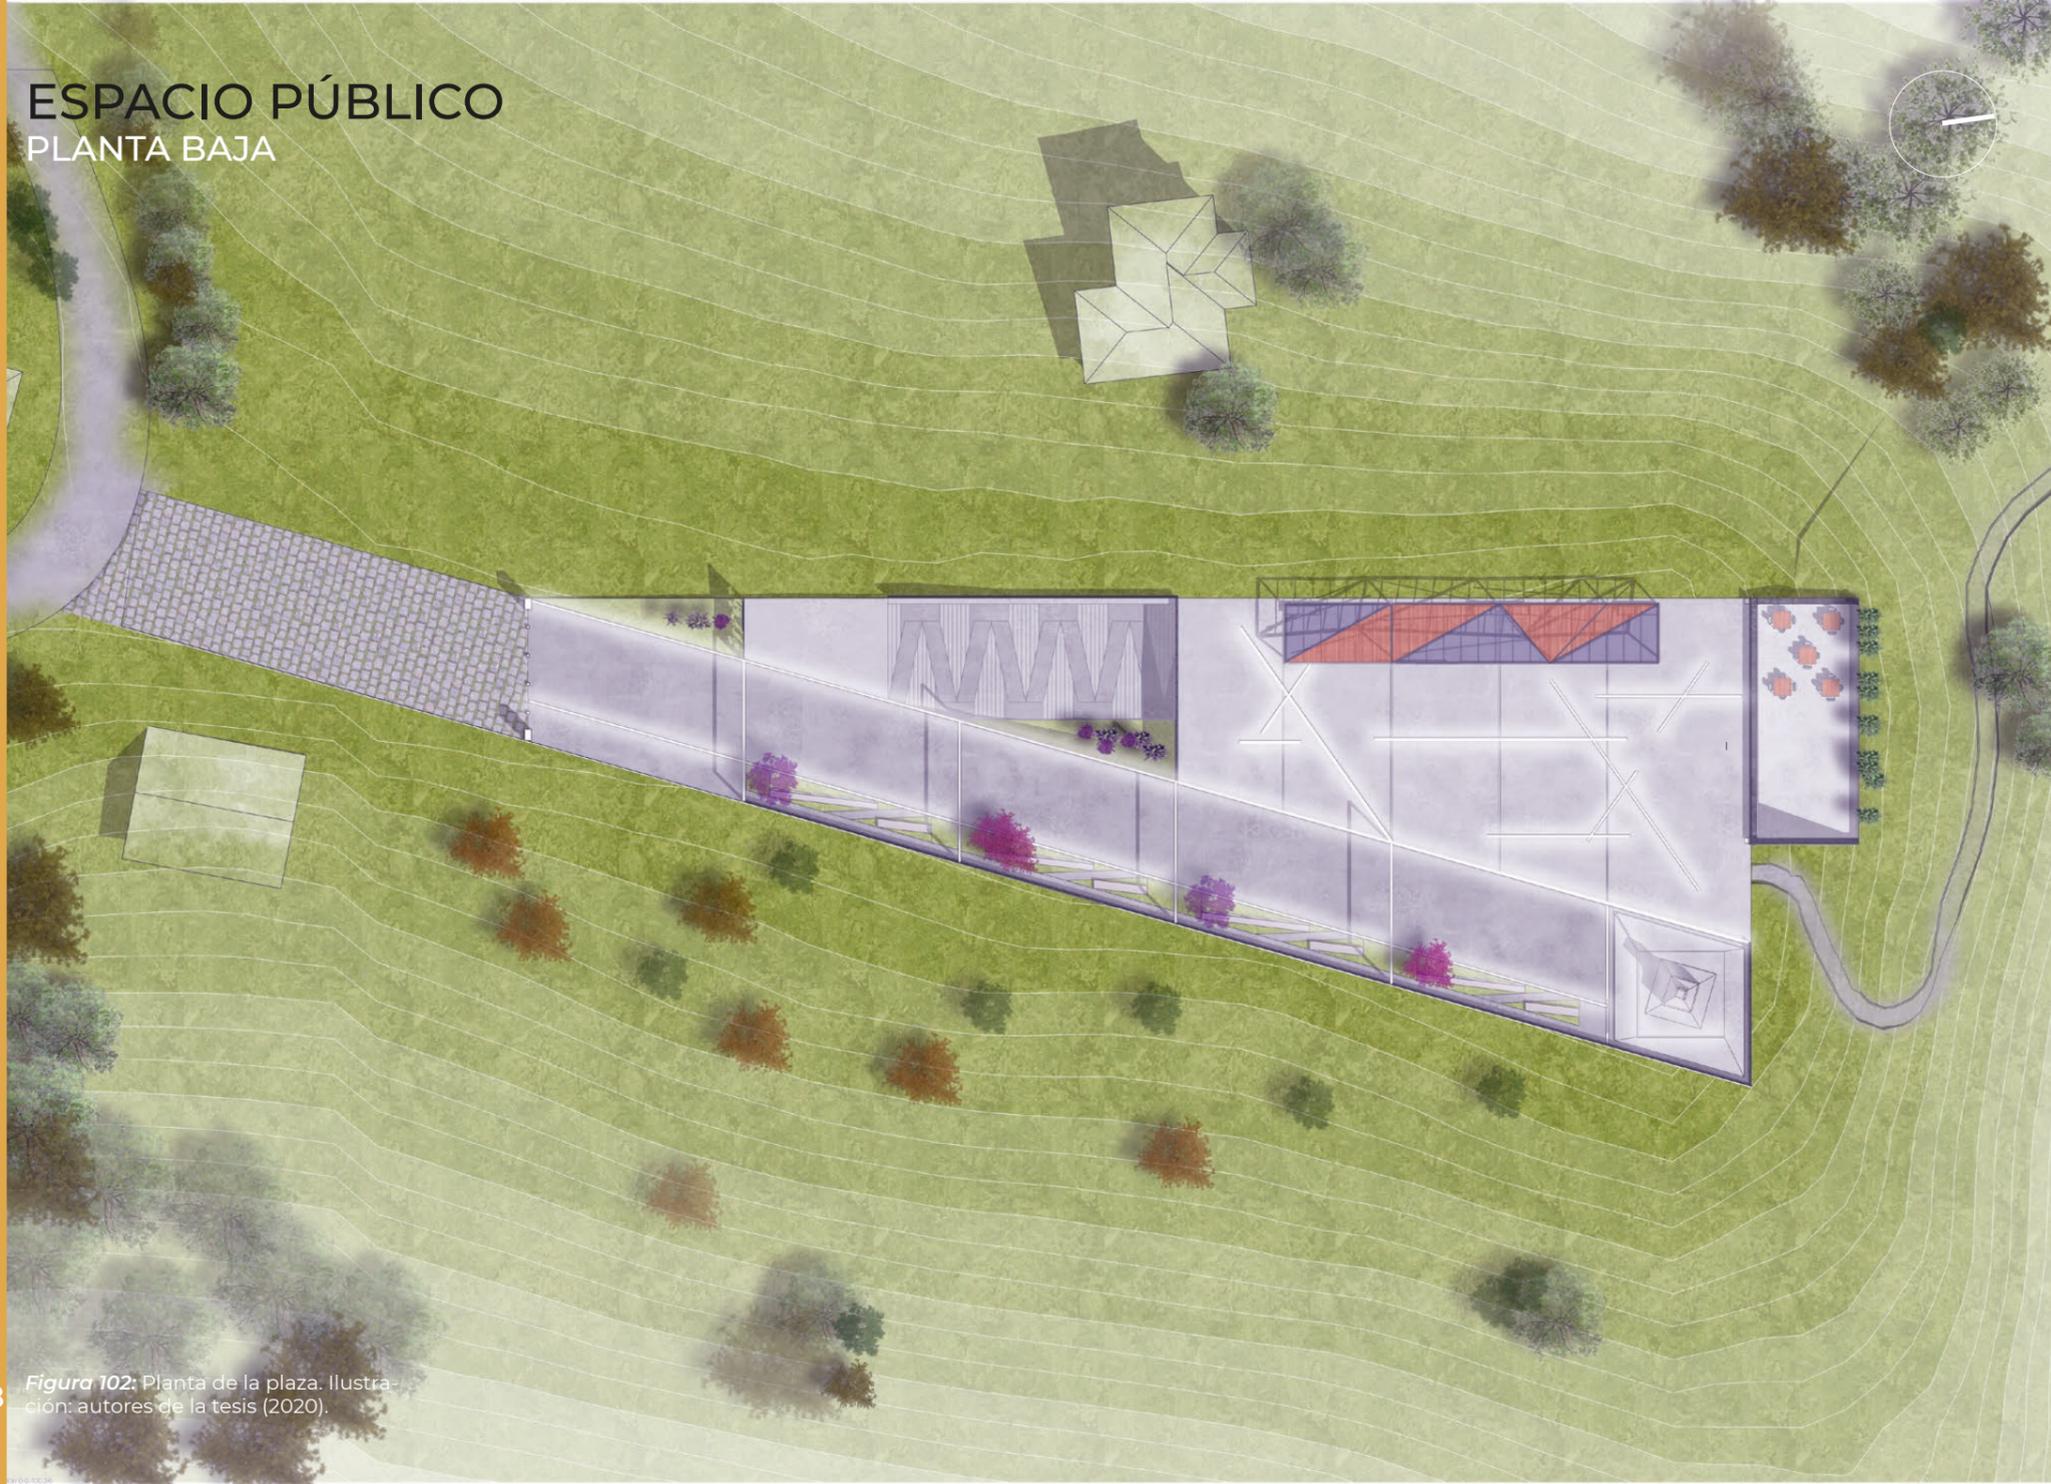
Planta de la plaza. Ilustración: autores de la tesis (2020).
